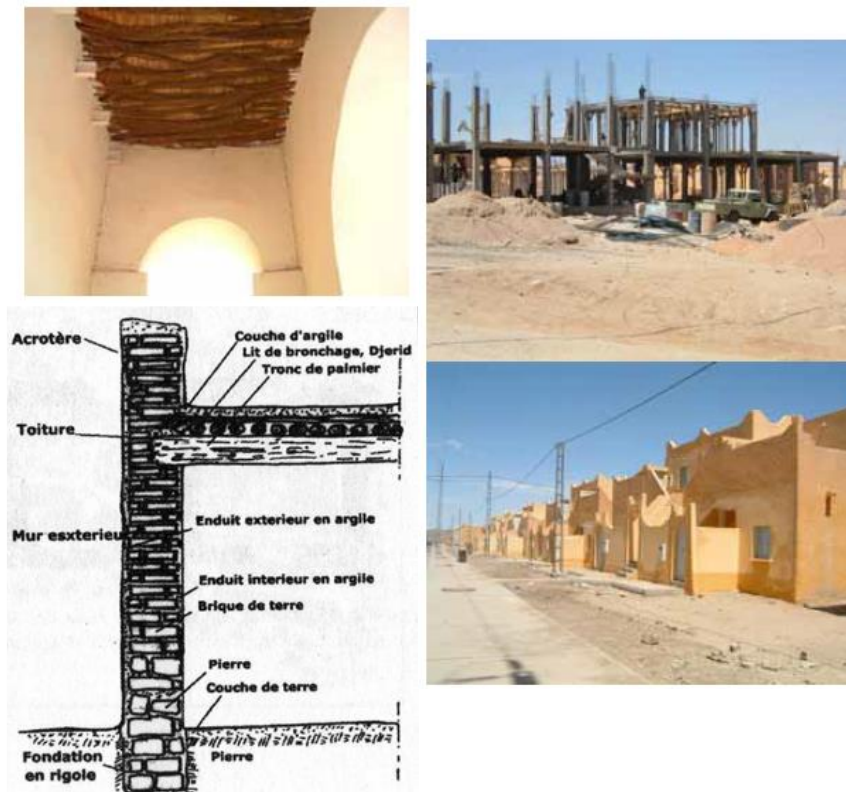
42.43. 44 : Matériaux et système constructif traditionnel et contemporain dans la ville de Tamanrasset (Source : M. COTE 2006, Photo. Chelghoumet al., 2011).
